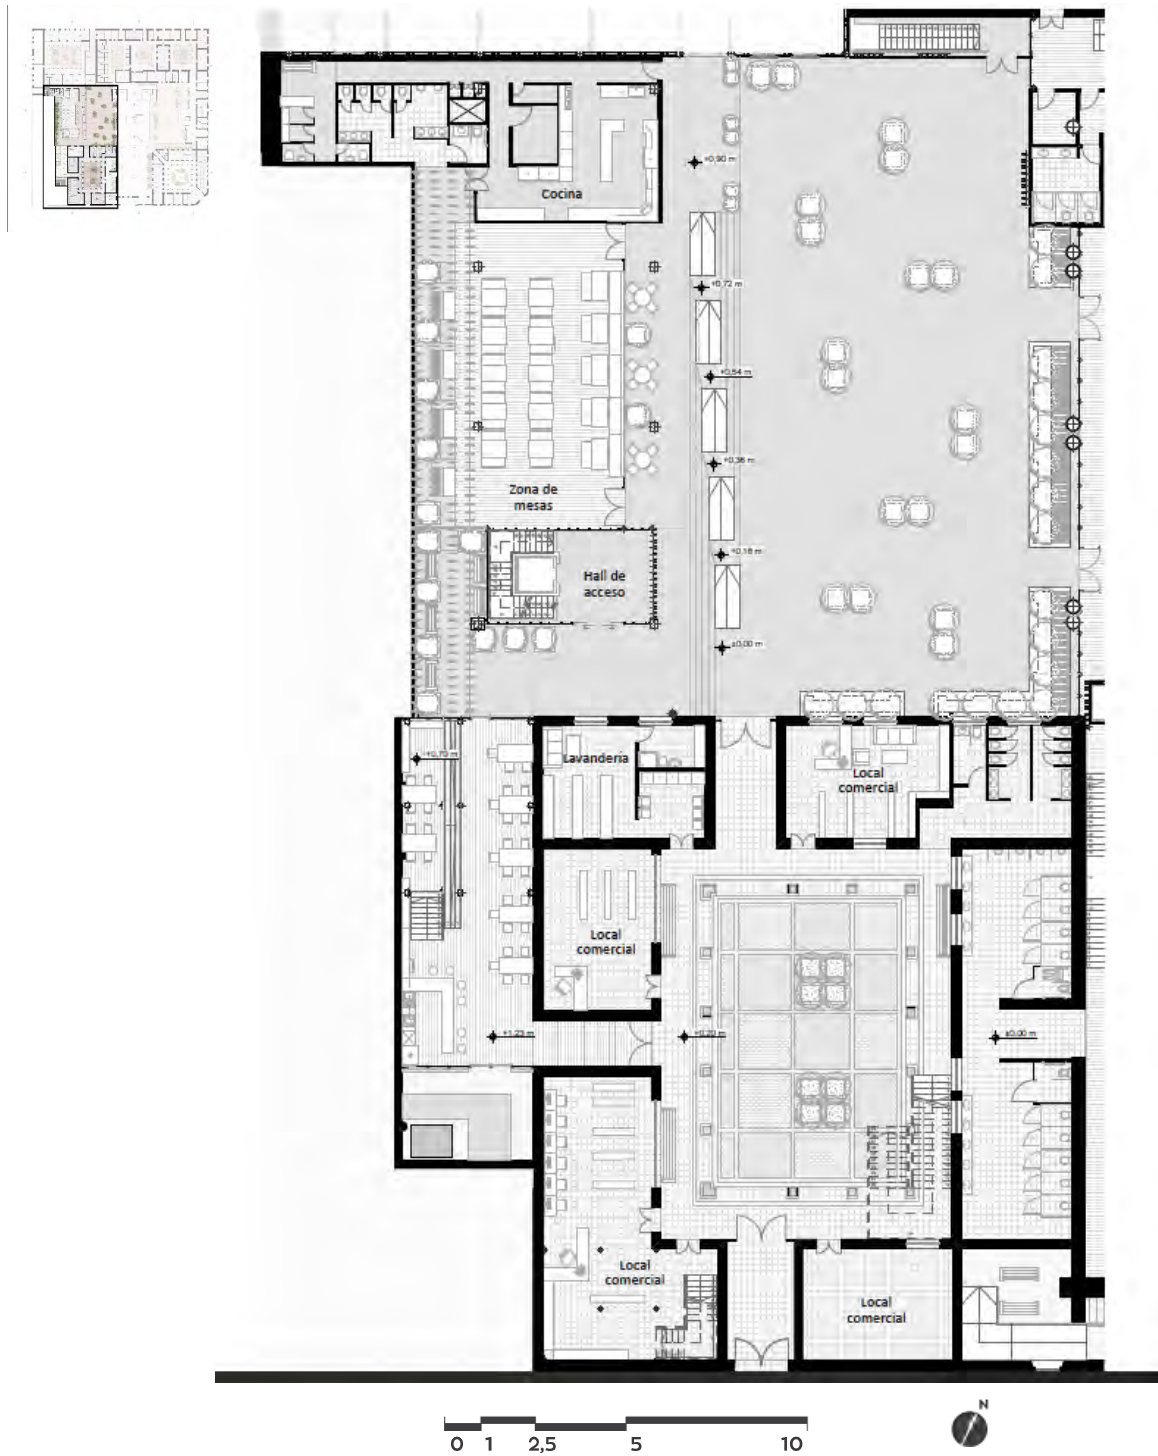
Planta Primera Alojamiento y Hostal. Fuente: Elaboración Popia.
